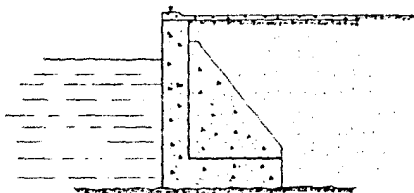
Muelle de concreto armado tipo muro milán.
